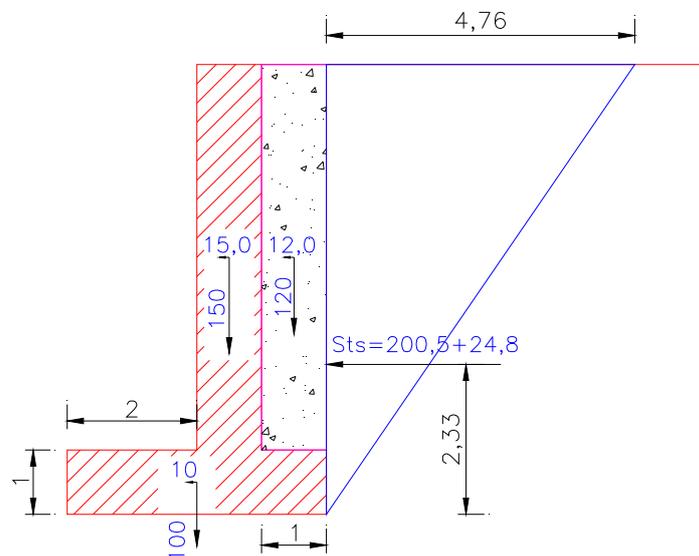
Spinta statica e sismica per verifiche fondazione
